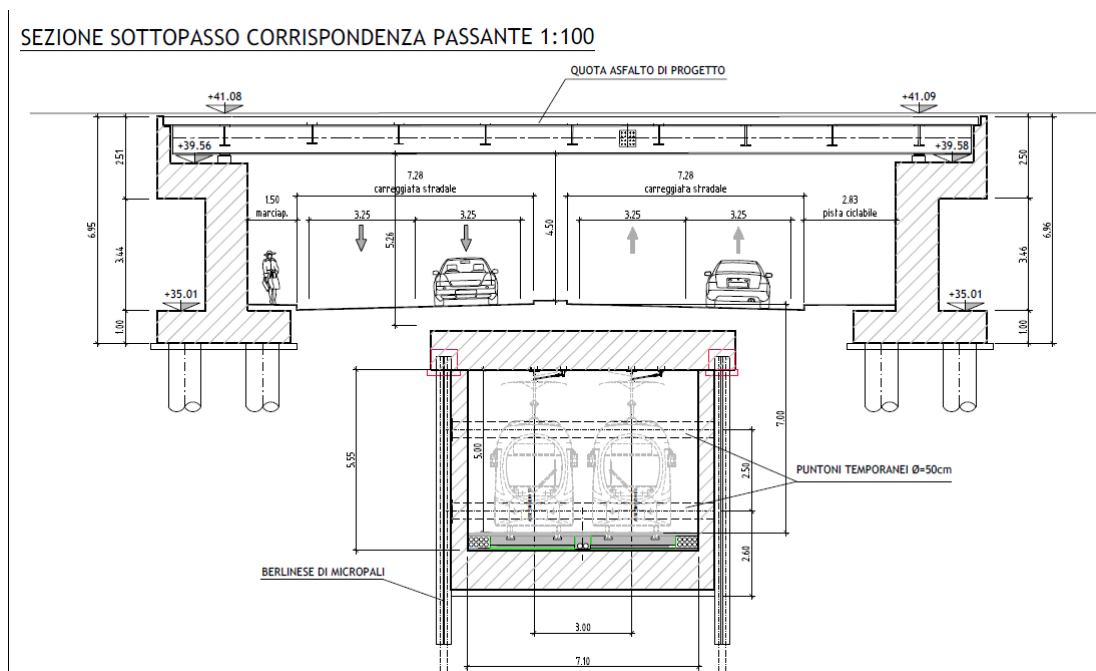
Sezione trasversale sottopasso in corrispondenza del Passante (estratto da elaborato B831-C-SF-STR-RT002)
